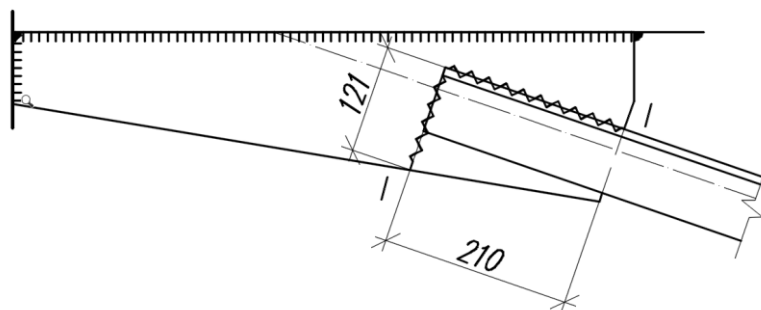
Расчетное сечение для расчета фасонки на вырыв.
